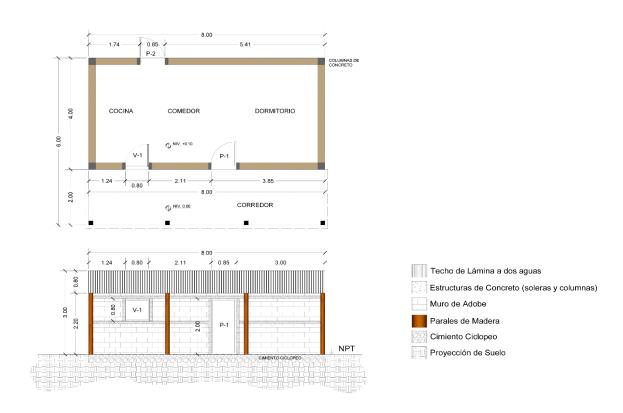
Tipo D, vivienda de adobe y estructuras de concreto
